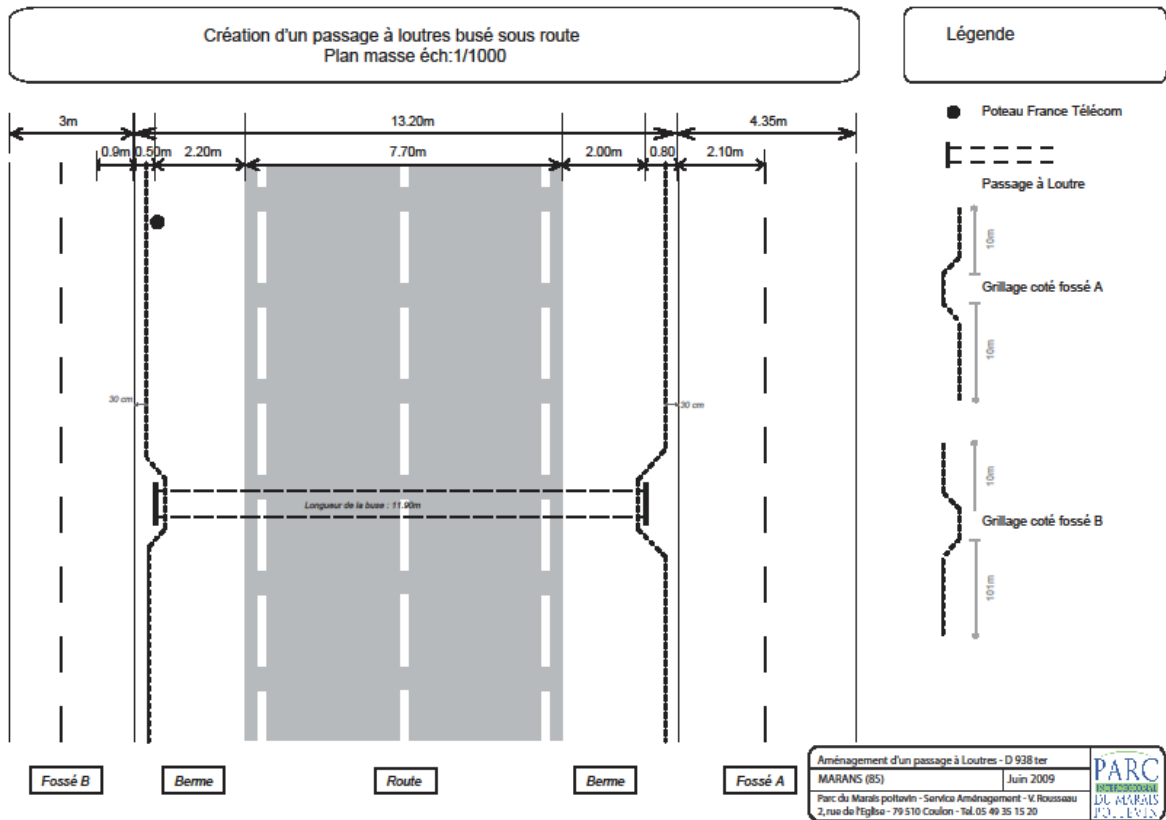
Plan d'aménagement d'un passage à Loutres - D938 ter
